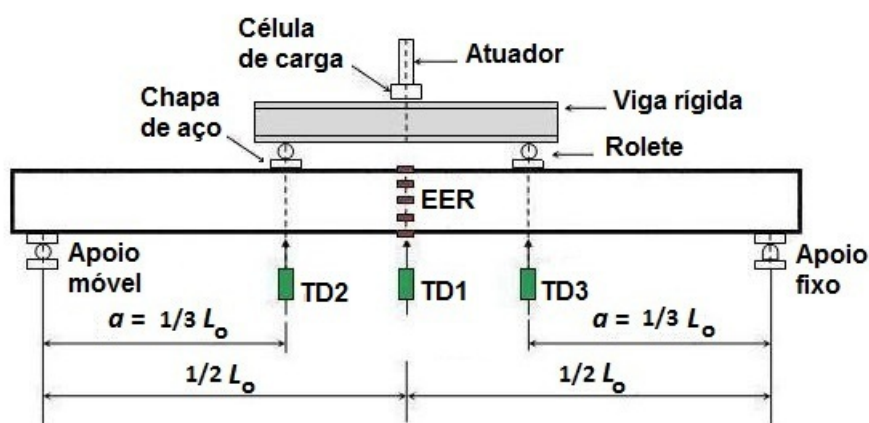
Ensaio de flexão: esquema para as vigas de aço (protótipos FLX-VA)
